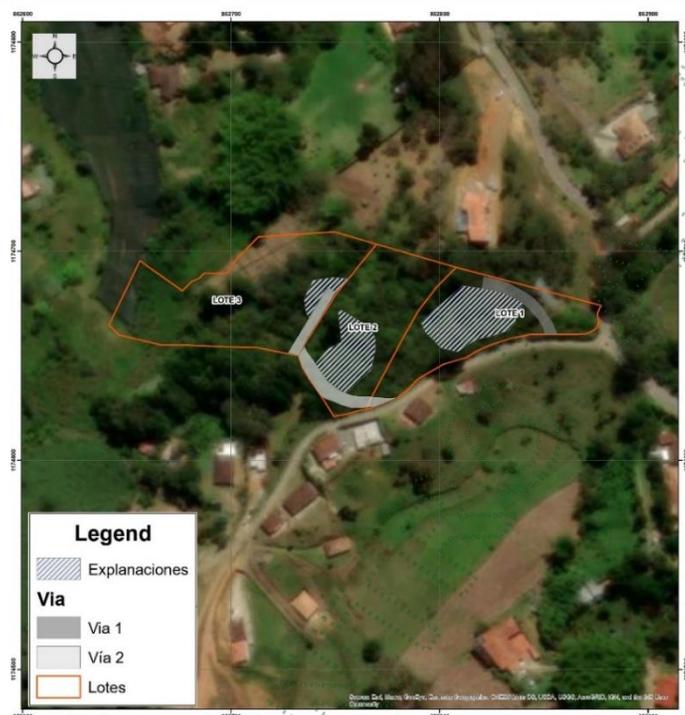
Levantamiento Planimétrico y Topográfico - Cálculo de Explanaciones. *Tomado y adaptado de la solicitud.
